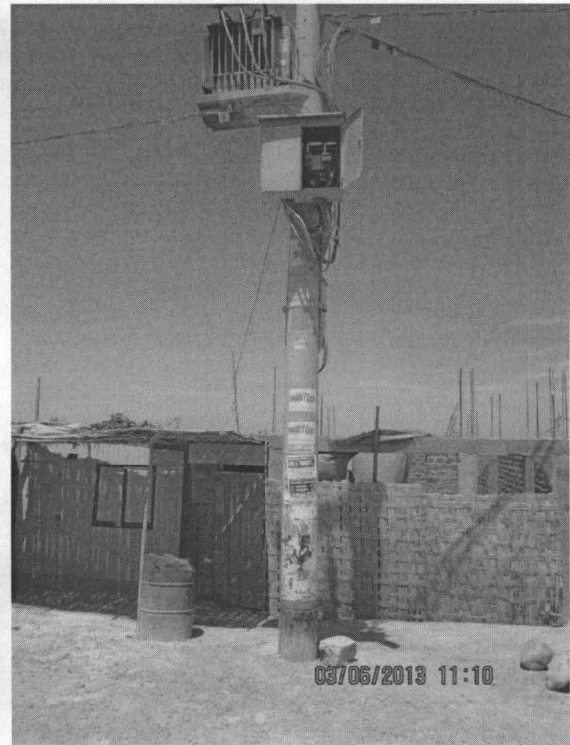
Ubicación del equipo con derrame y rotulo rojo debajo de las viviendas (070)
